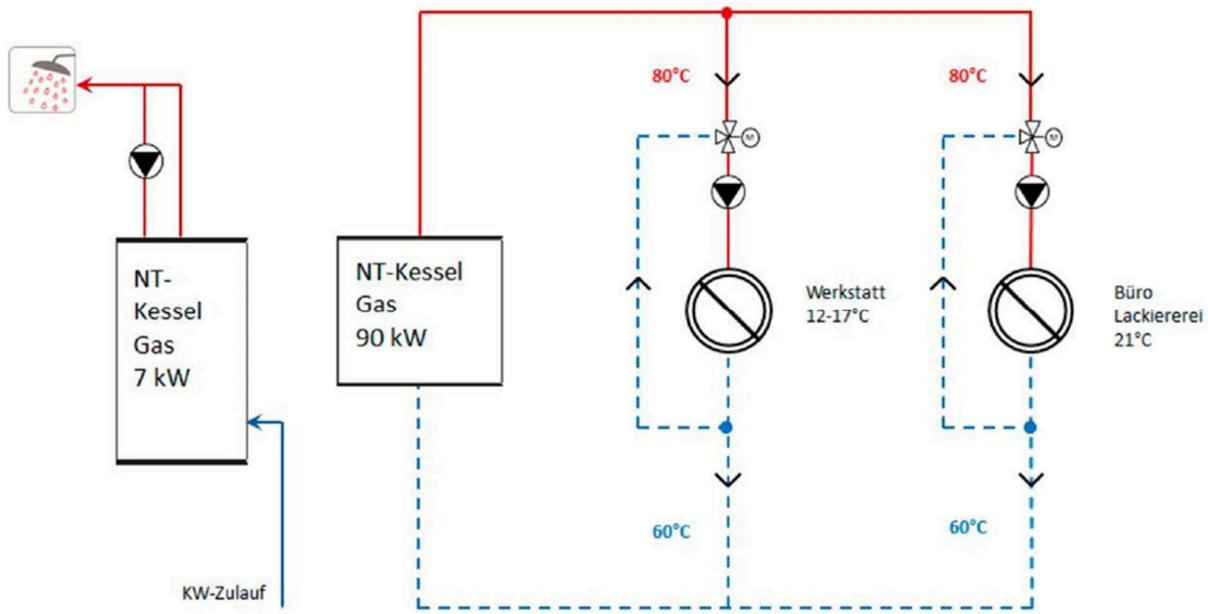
Schema Wärmeversorgung, Betriebswerkgebäude ABz Köln
